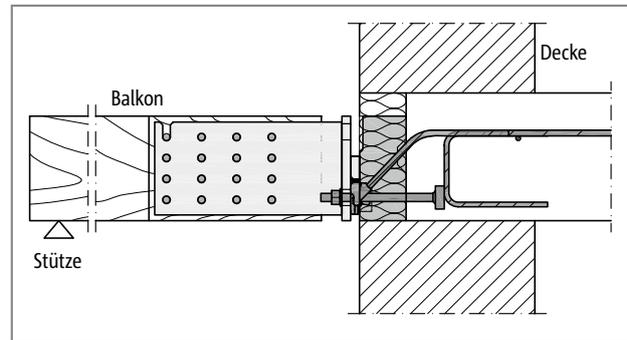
Schöck Isokorb® T Typ SQ mit Stahlschwert: Anschluss an die Stahlbetondecke bei monolithischer Außenwand
